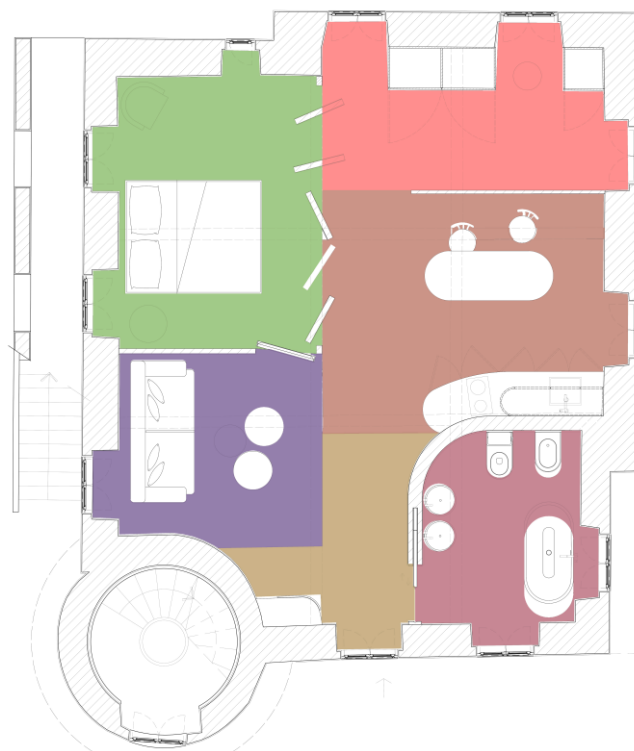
Planta de Zonamentos, Estúdio D.João V- Piso 0 ; Fonte: Beatriz Cordeiro
